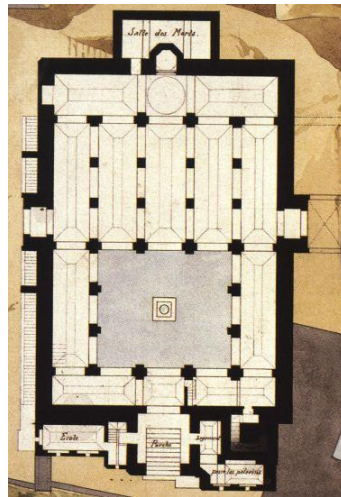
Plan de Djamaa de Sidi Bou Madyan.
